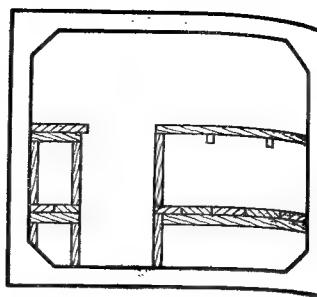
Убежища из замкнутых железобетонных блоков
